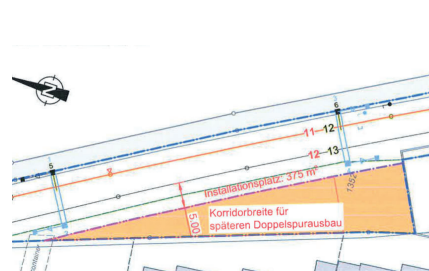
Ausschnitt Landerwerbsplan BLS Parzelle Nr. 1352: Abtretung der BLS
